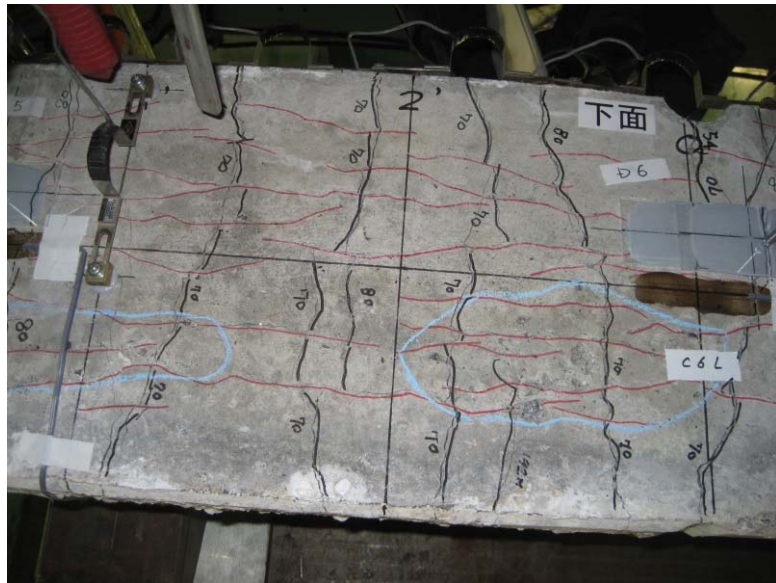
Pmax96.9kN 載荷時 G3 桁下面ひび割れ状況 (4'位置：PI-18)
